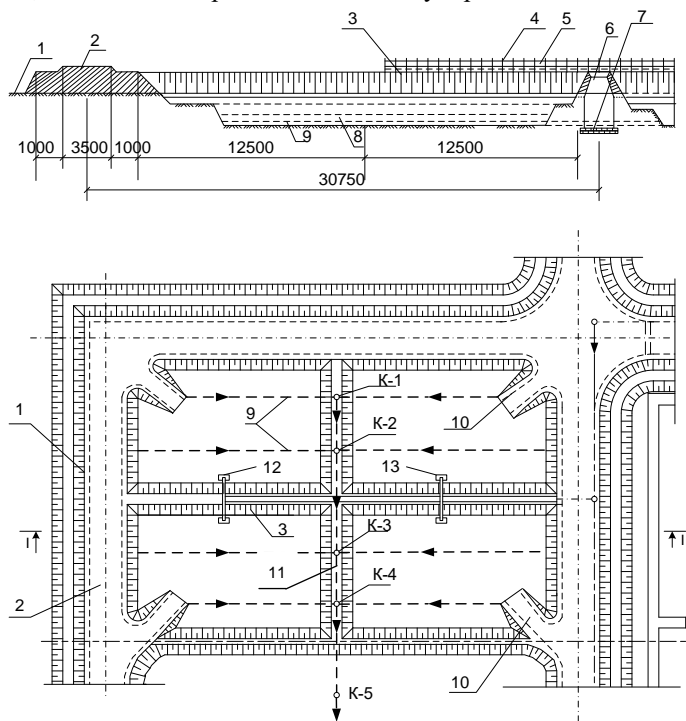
Иловые площадки (план, разрез 1-1):
